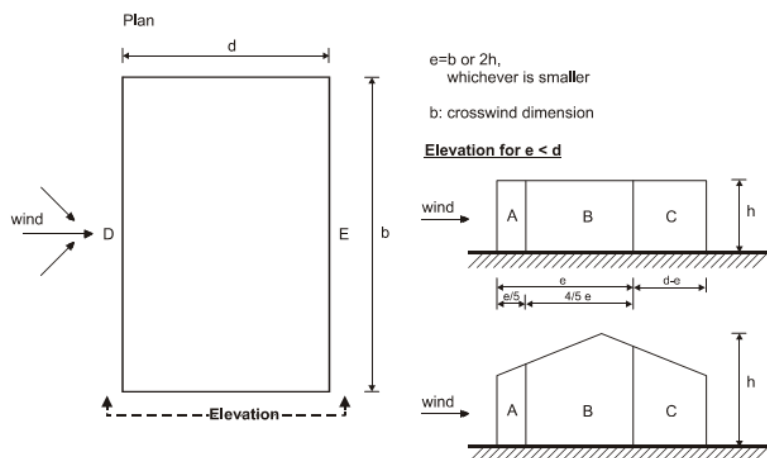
Zonas em paredes verticais com o vento a ser aplicado nas fachadas laterais [60].
